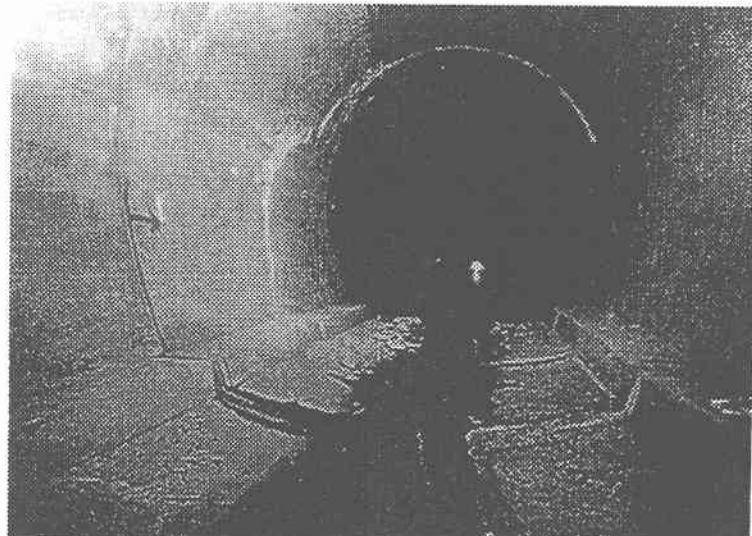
塩屋谷川放水路のリング状のひび割れ
